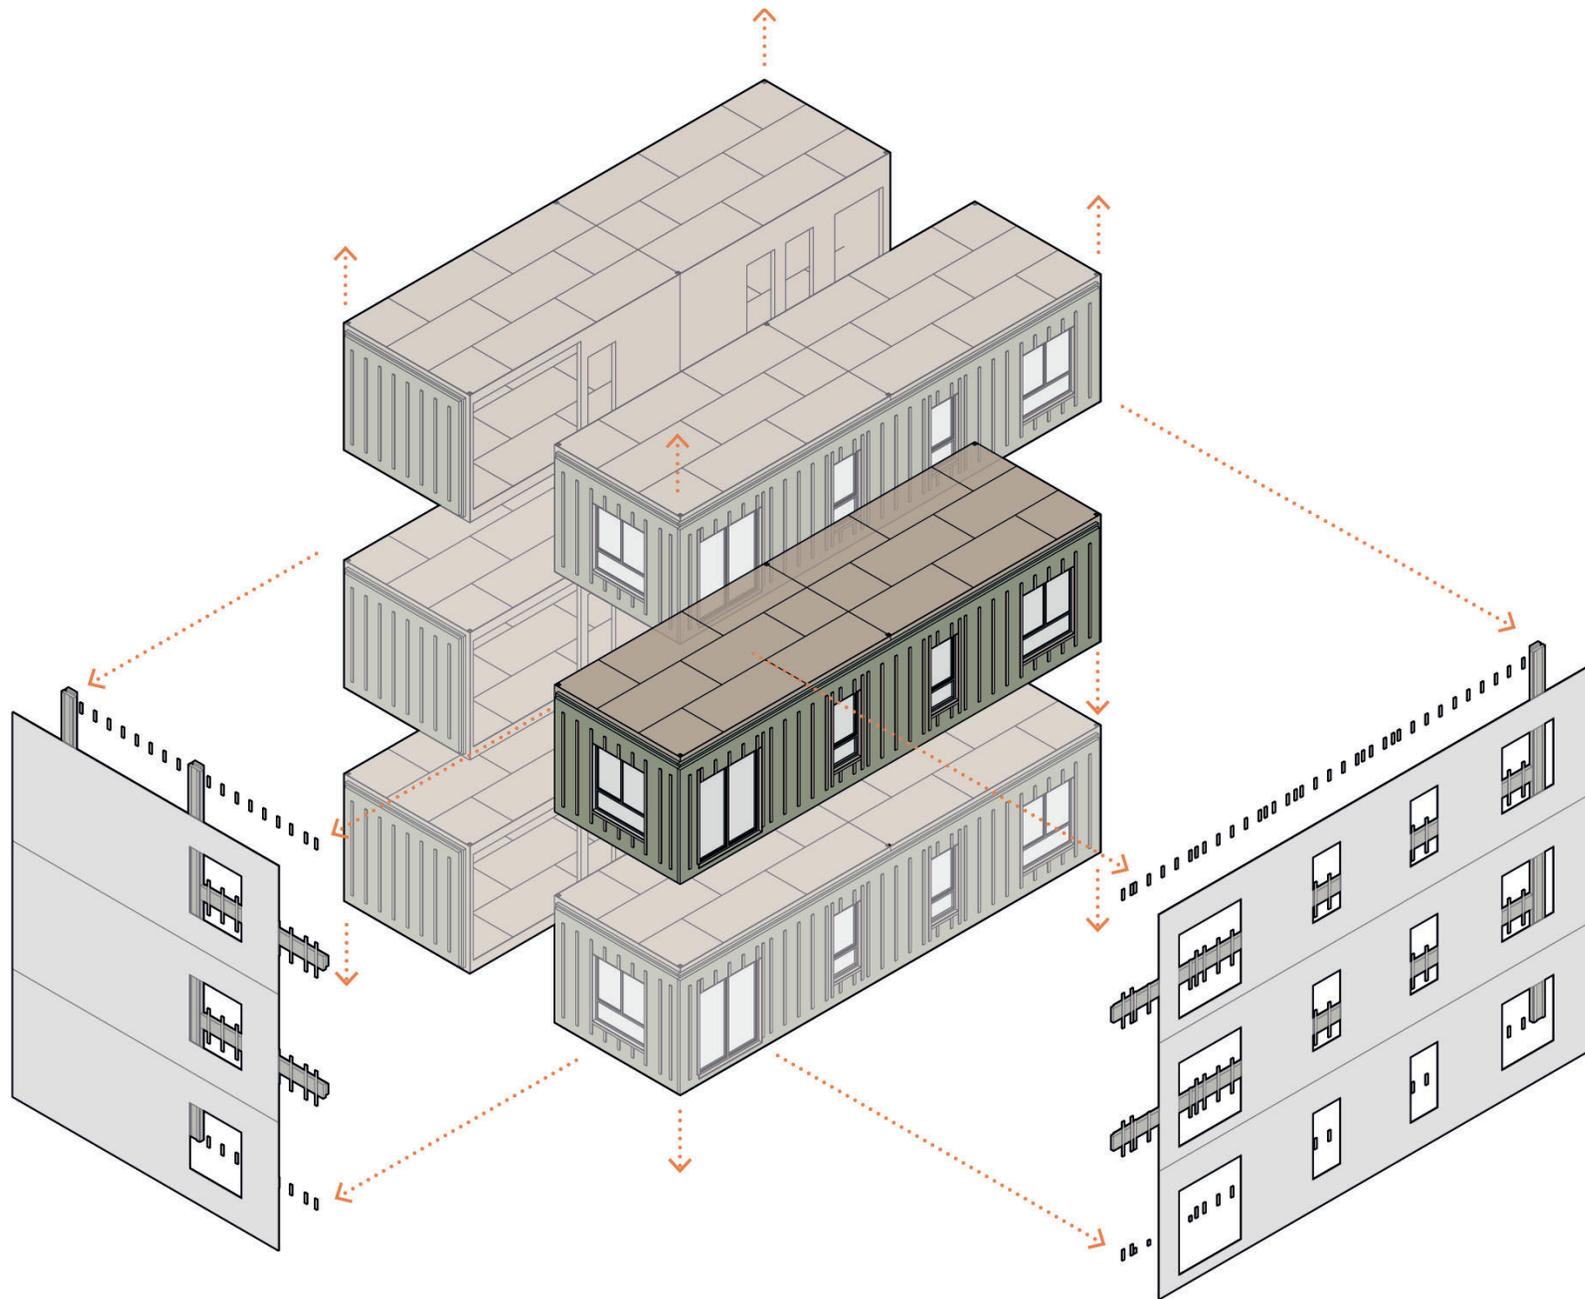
Déconstruction au niveau du Module (source: BOON architecture)
